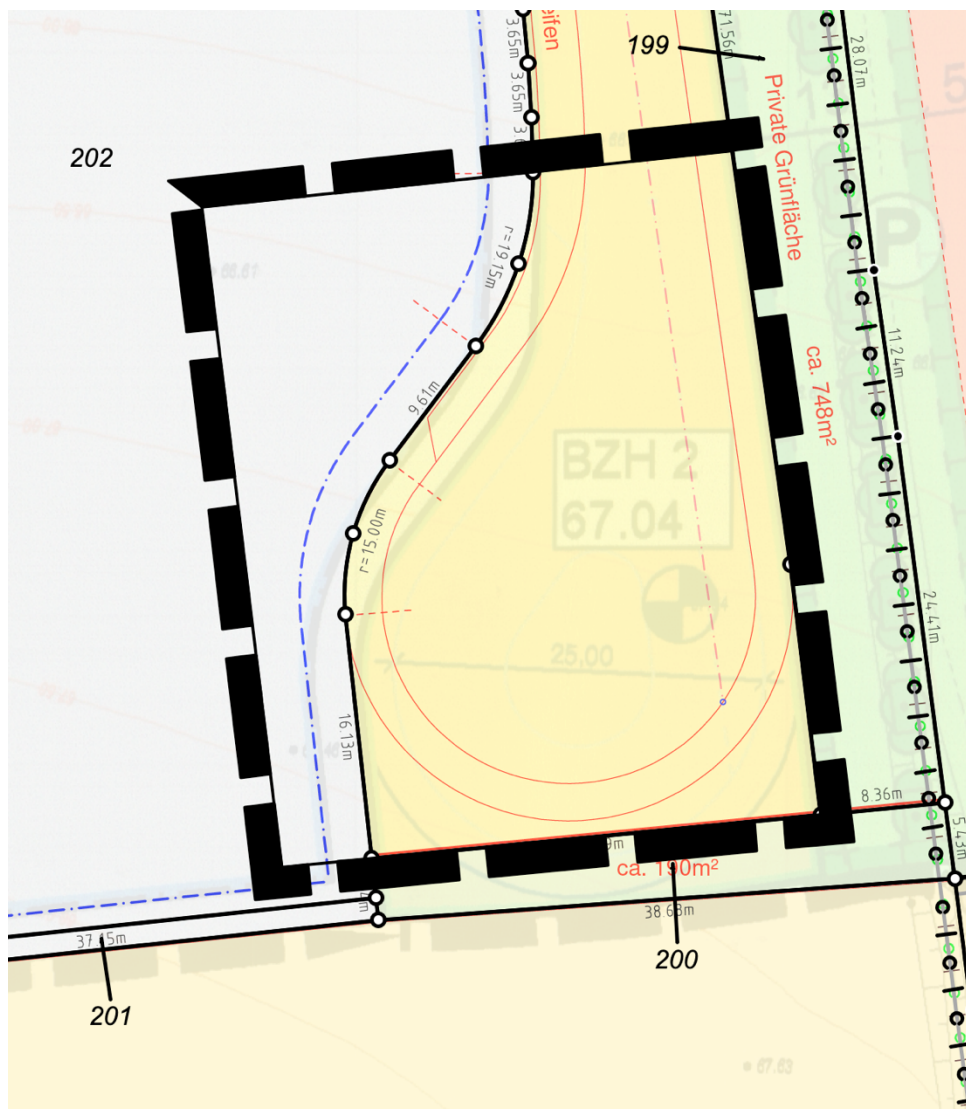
Überlagerung Bebauungsplan Nr. 51 und Erschließungsplanung, A+S Hamburg, 28.04.2025
